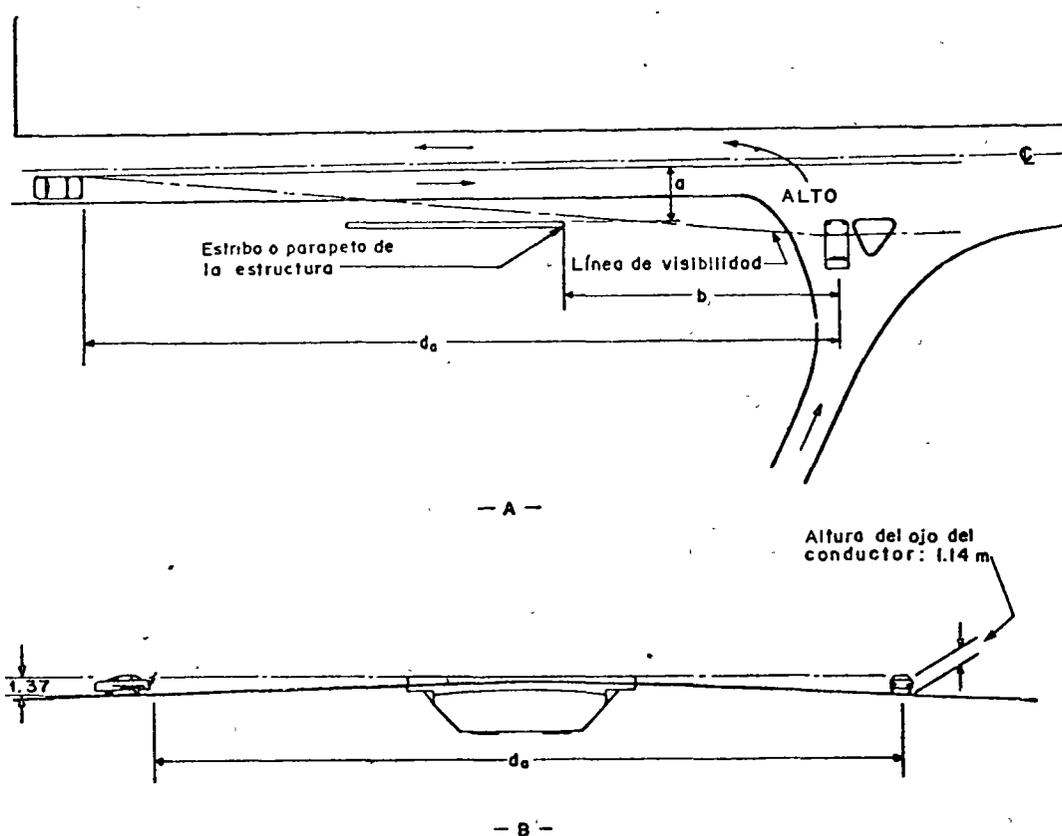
DISTANCIA DE VISIBILIDAD REQUERIDA EN LOS EXTREMOS DE RAMPAS CERCANAS A ESTRUCTURAS
